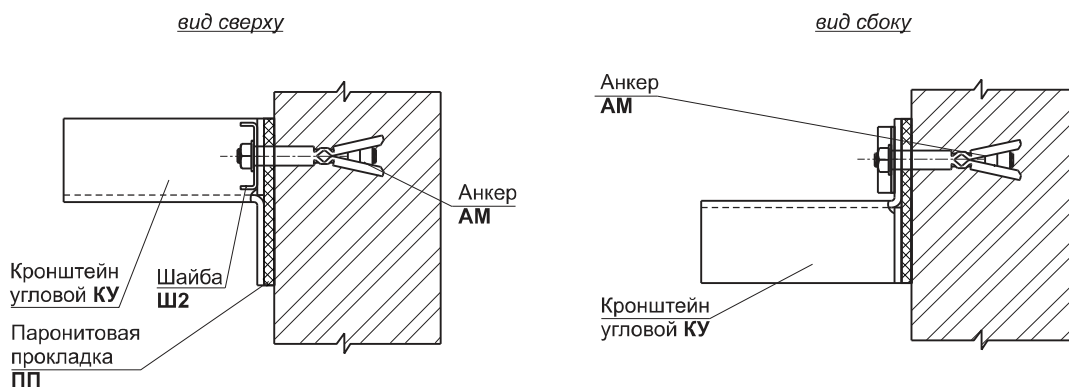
Узел крепления кронштейна КУ к стене одним анкером.
